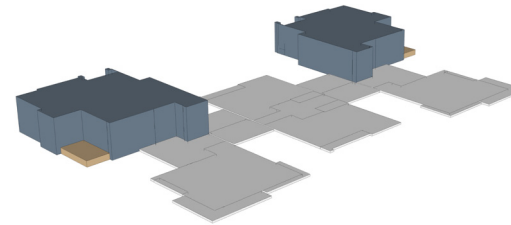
Planta dúplex 5 usuarios: T1 planta baja
